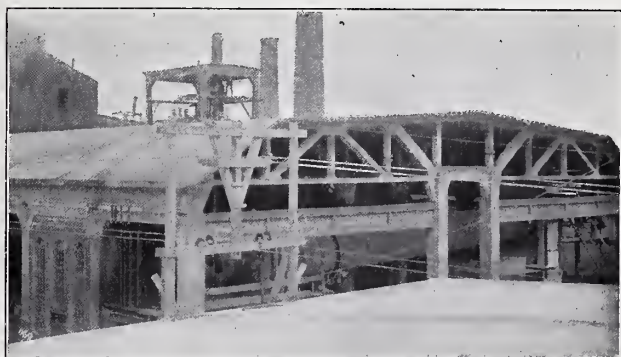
Rieslerkammer mit Eisenbetonrosten.
